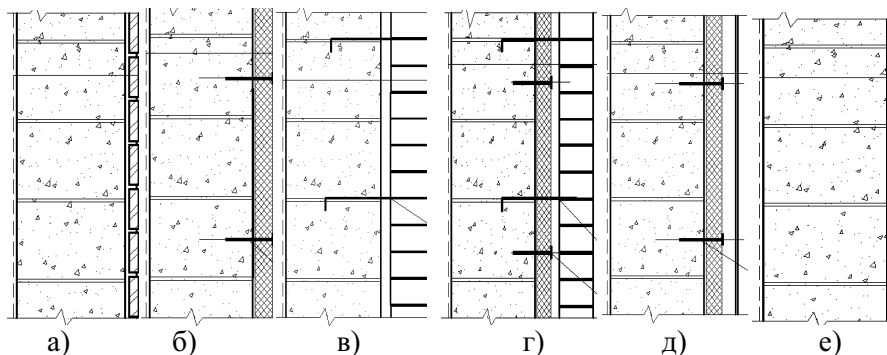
Конструктивные решения и системы отделки стен из автоклавного газобетона: а) облицована плиткой керамической; б) с тонкослойной системой утепления; в) облицована кирпичом с вентилируемым воздушным зазором; г) облицованная кирпичом с дополнительной теплоизоляцией; д) с «навесным вентилируемым фасадом»; е) однослойная стена отделанная штукатуркой
